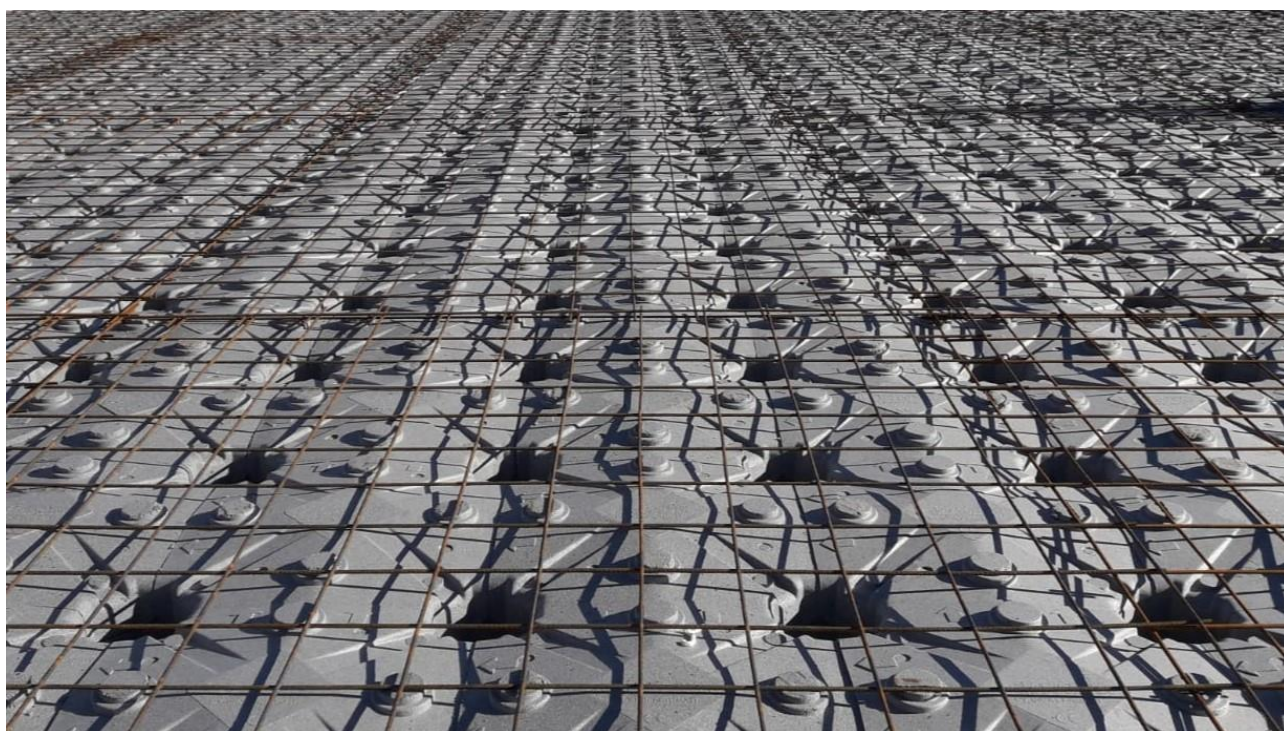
Posa del sistema Aircrab® per fondazioni aerate con isolamento termico integrato - Cantiere di Cavour (To).
